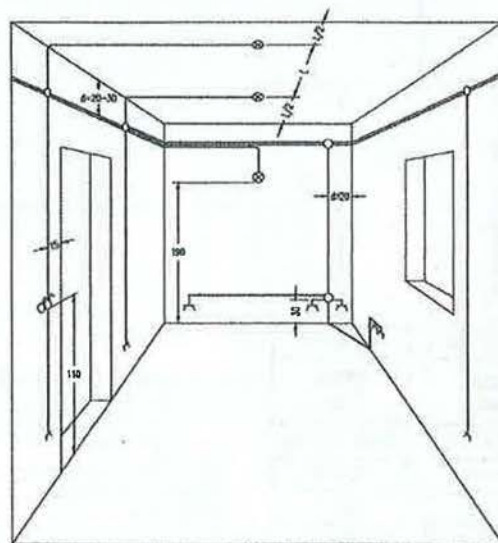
Plano acotado del trazado de las canalizaciones en 3D. Cotas en centímetros.
